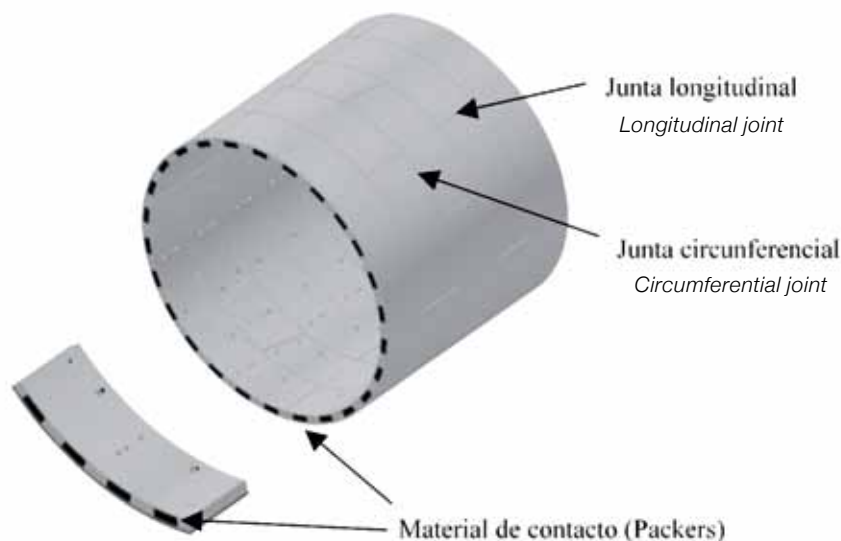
Revestimiento de túnel a base de dovelas prefabricadas de hormigón/Prefabricated concrete segmental tunnel lining
